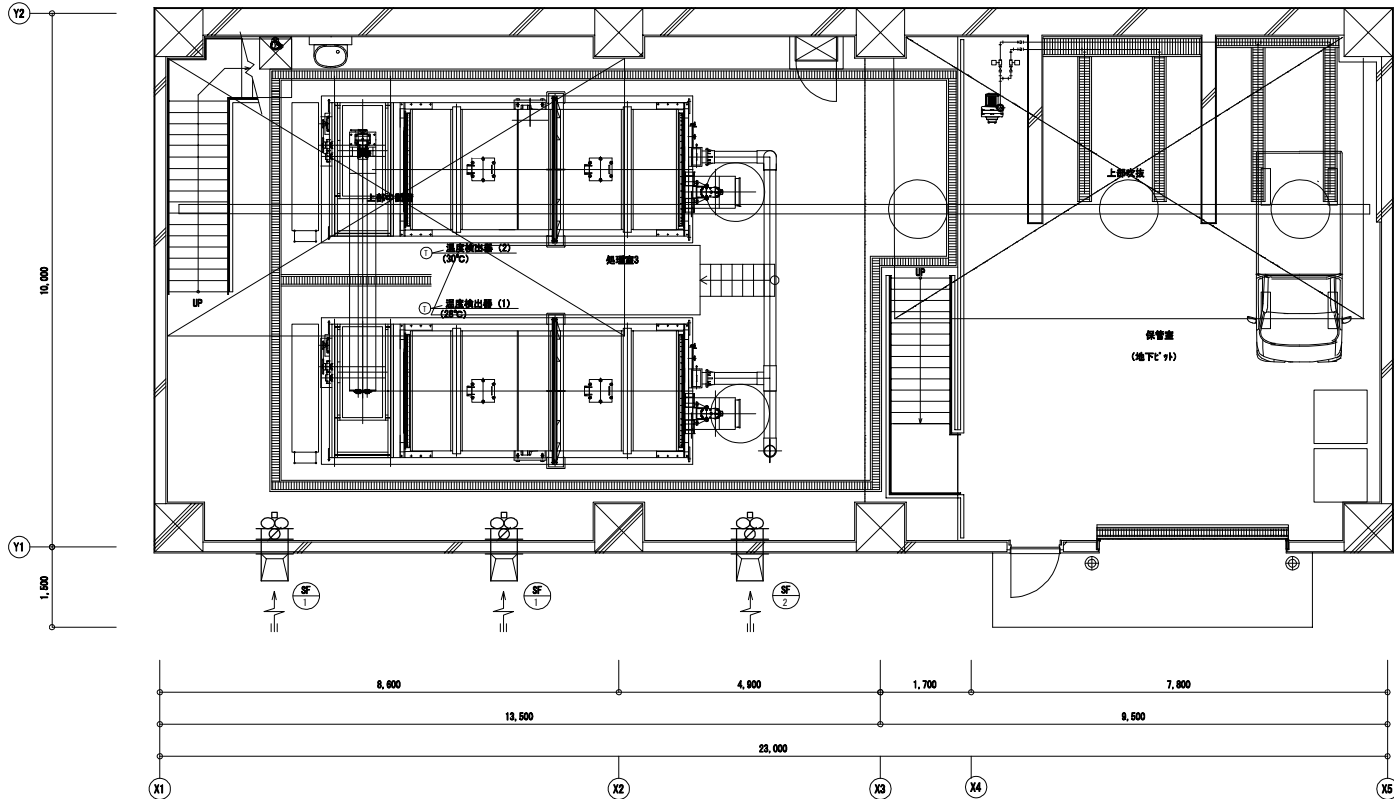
バイオ発酵処理施設 換気設備 B2階平面図
